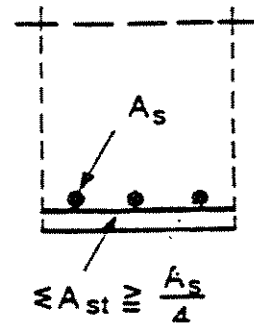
EC2 - Armatures de couture d'un ancrage
